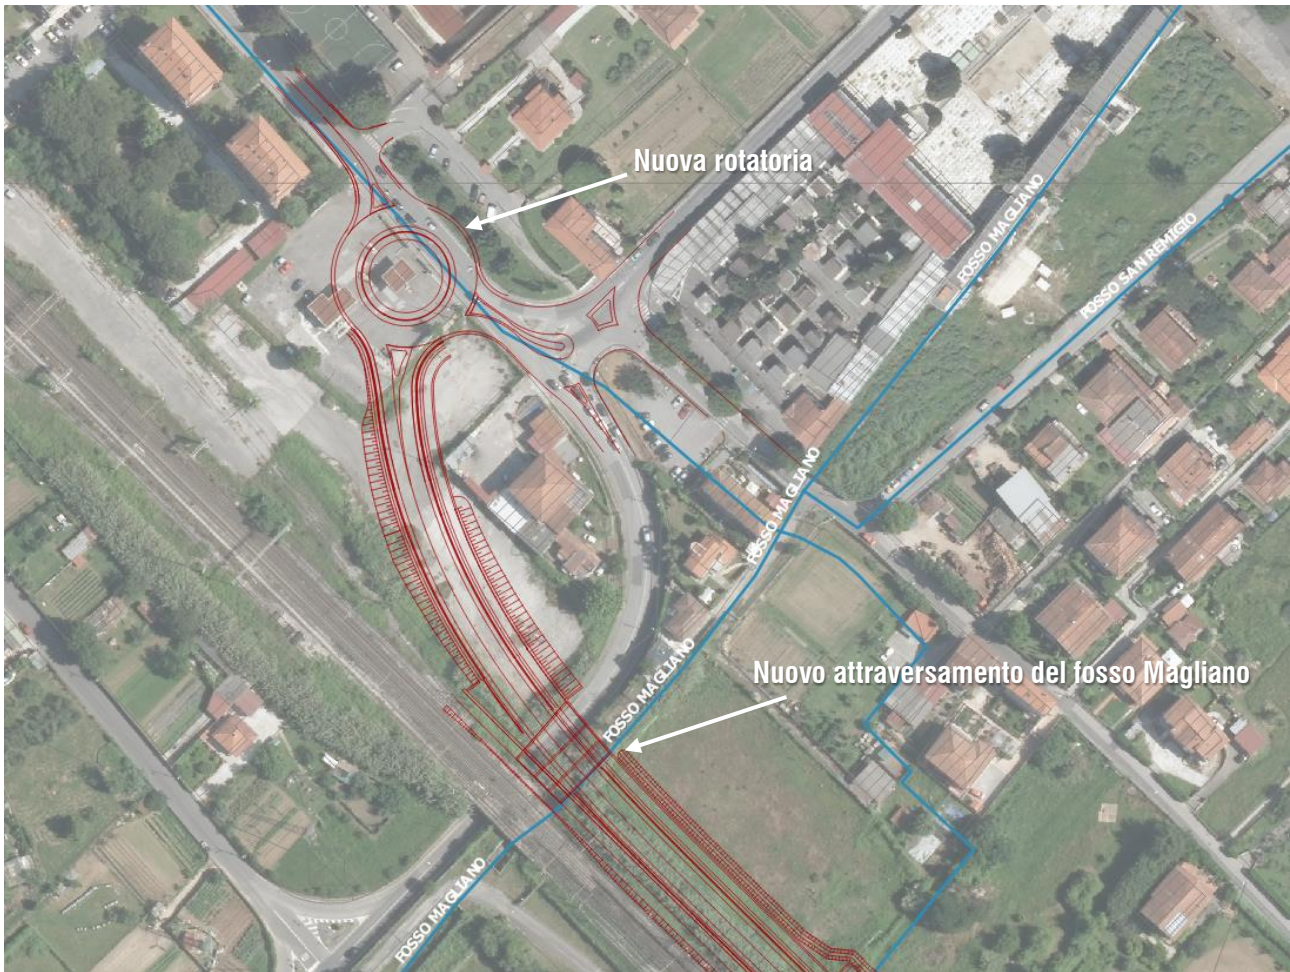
Progetto Definitivo - Tratto iniziale del tracciato stradale
